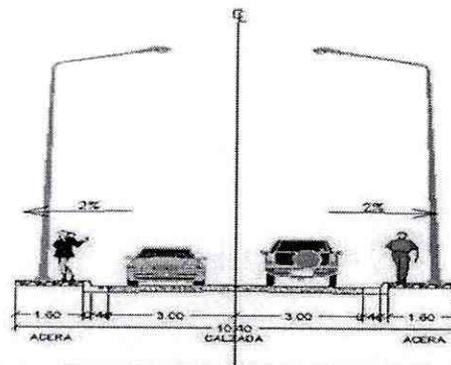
Sección transversal vía local unidireccional con estacionamiento en un lateral
